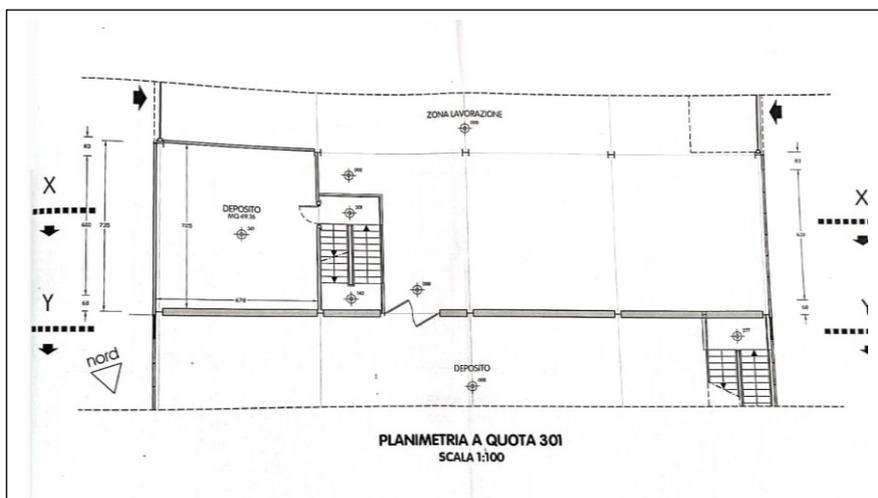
Variante di progetto relativa alla licenza edilizia n.35 del 2006. Piano ammezzato.
